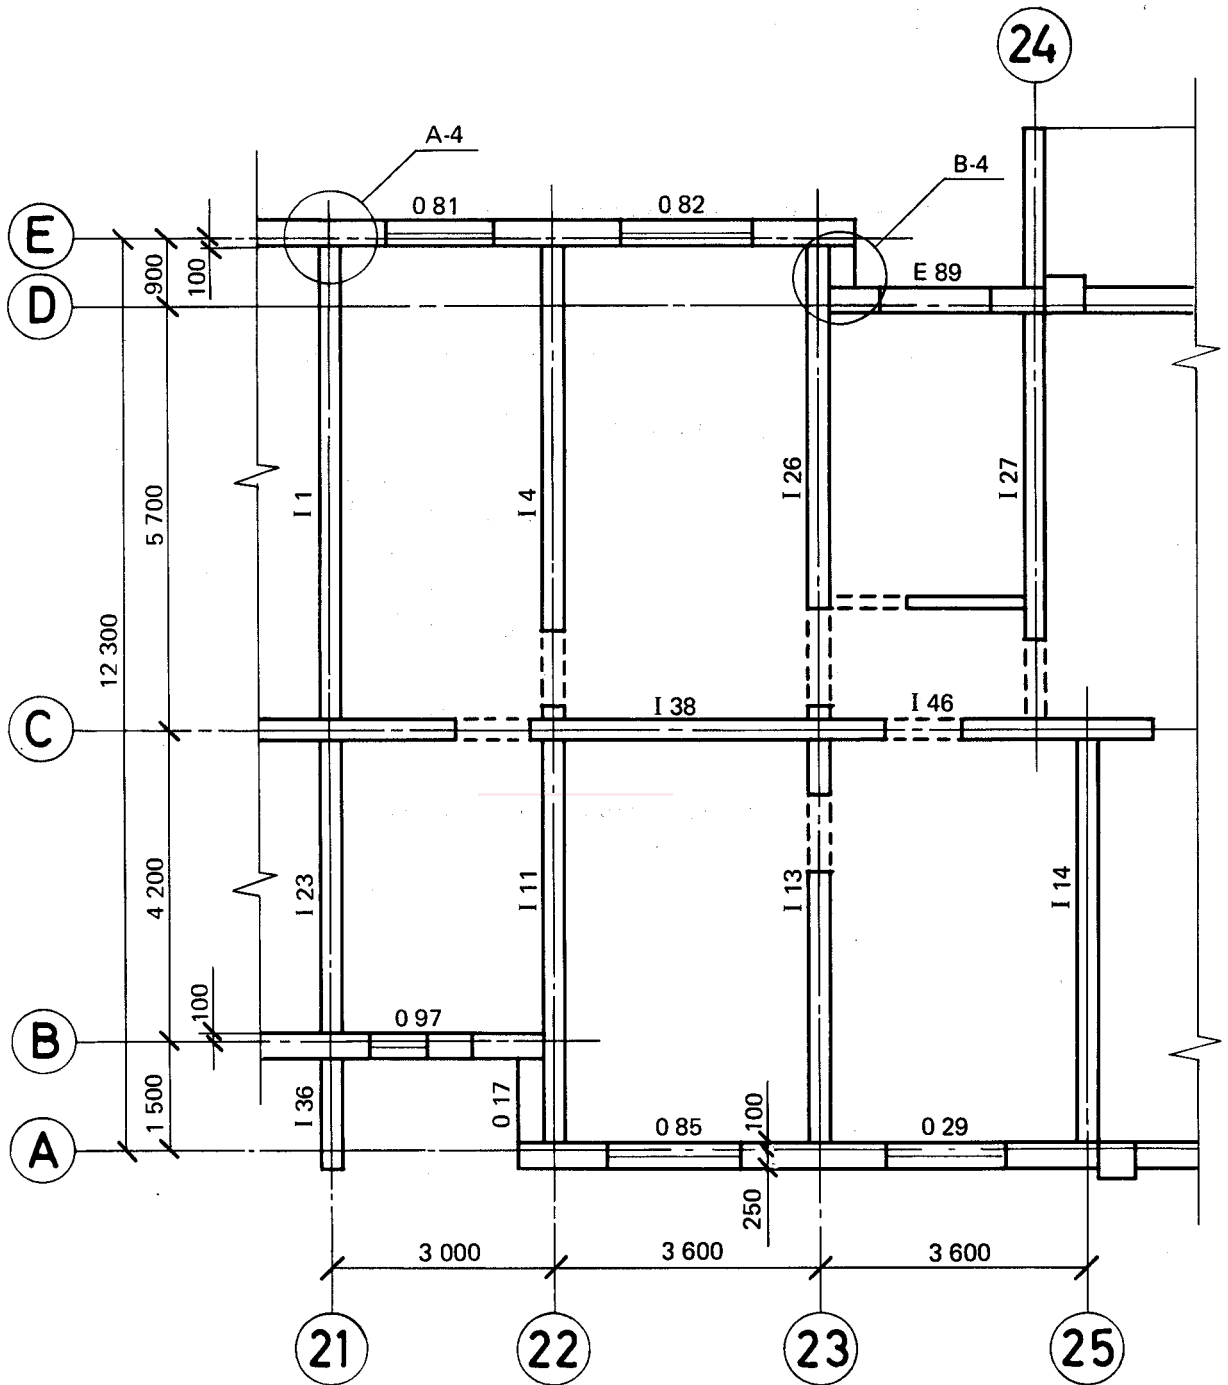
Exemple de dessin d'ensemble pour panneaux de murs
